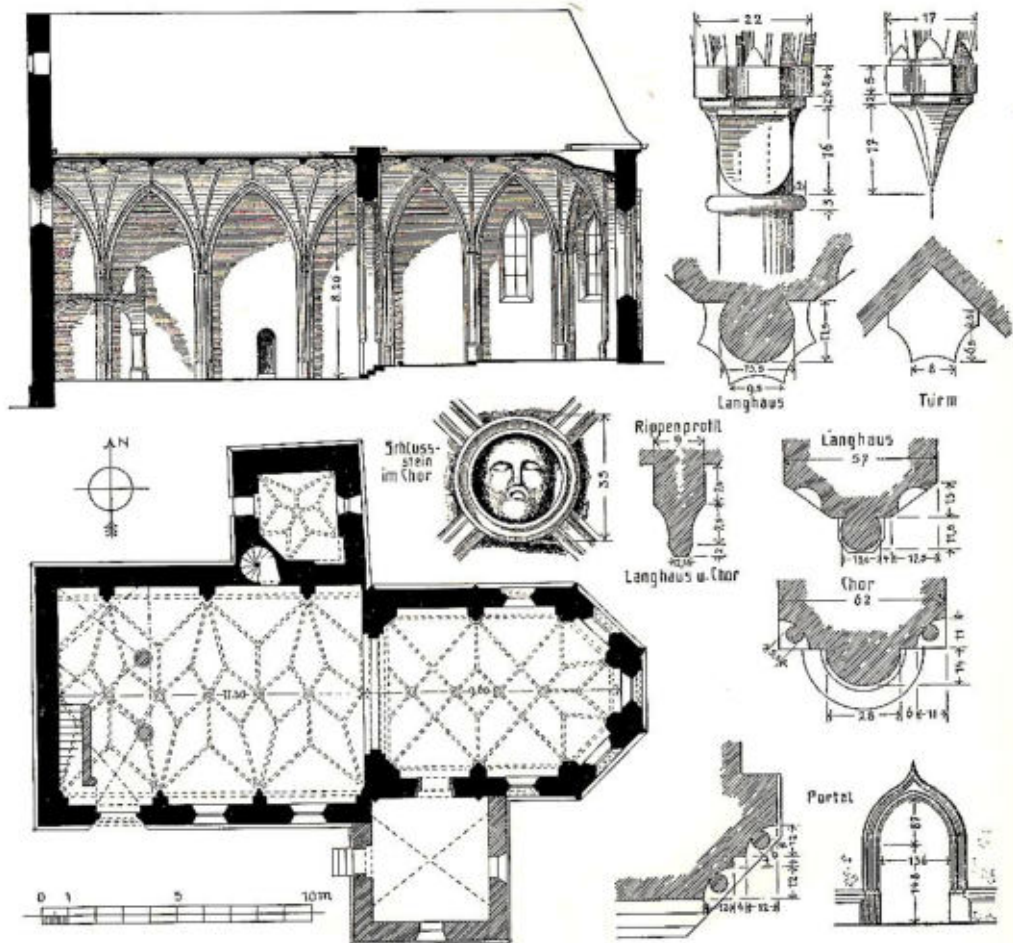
Erlach. Kirche. Grundriß, Längsschnitt und Teilformen.
